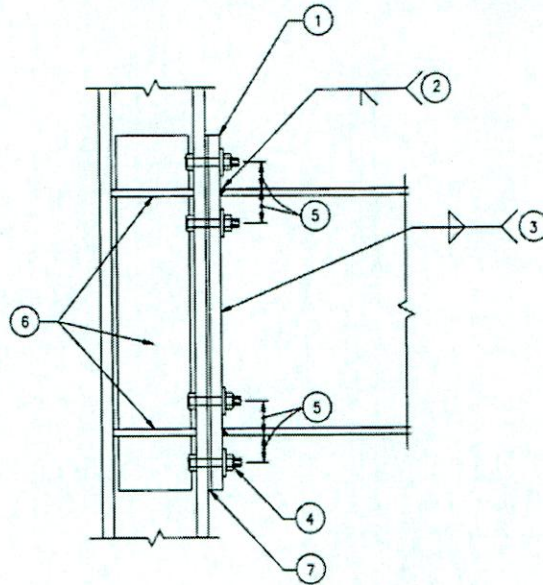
Conexión Apernada con Plancha extrema sin atiesador
